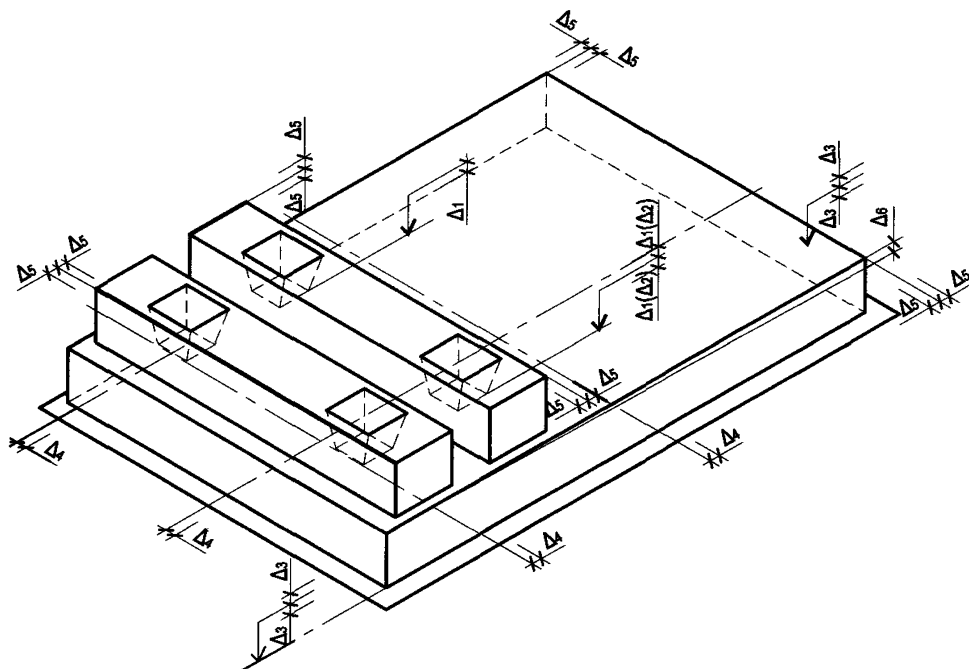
Схема монтажа фундаментных блоков устоев козлового типа с указанием предельных отклонений
